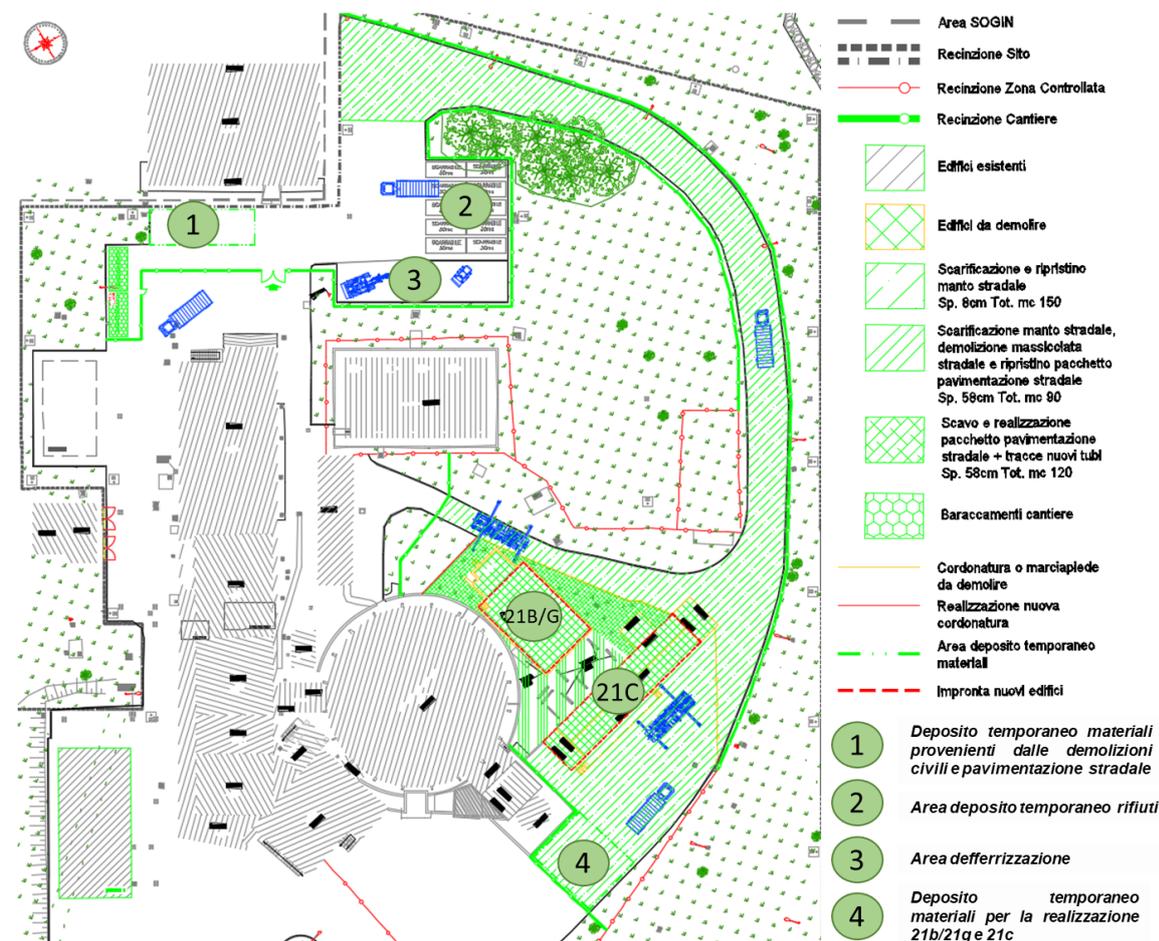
Adeguamenti edifici 21b/21g e 21c – Cantierizzazione
